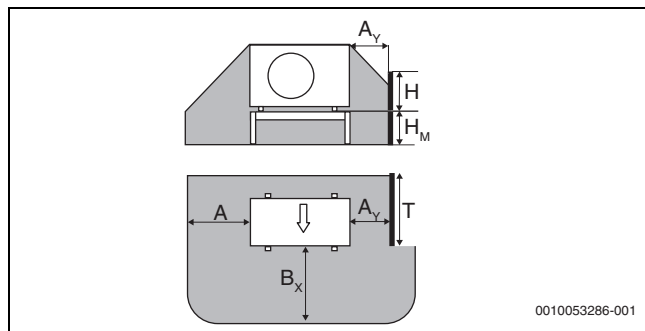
Schutzbereich mit Barriere rechts, Wärmepumpe auf Montagesockel
